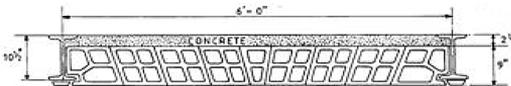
O arco de tijolos como primeira forma de proteção de vigas metálicas.
